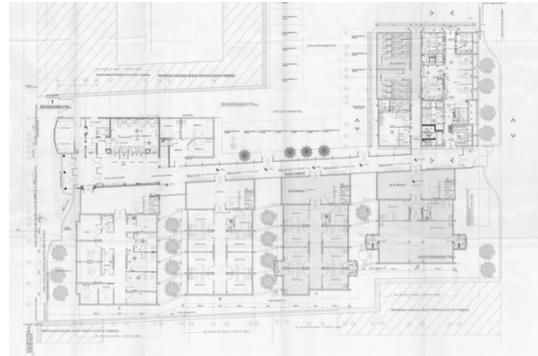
Modelo B Fuente: Elaboración propia a partir de planimetría obtenida en DOM.
